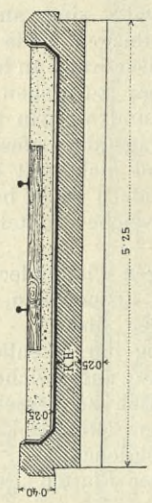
Durchlaß im Sicherungsbereich einer Station.
